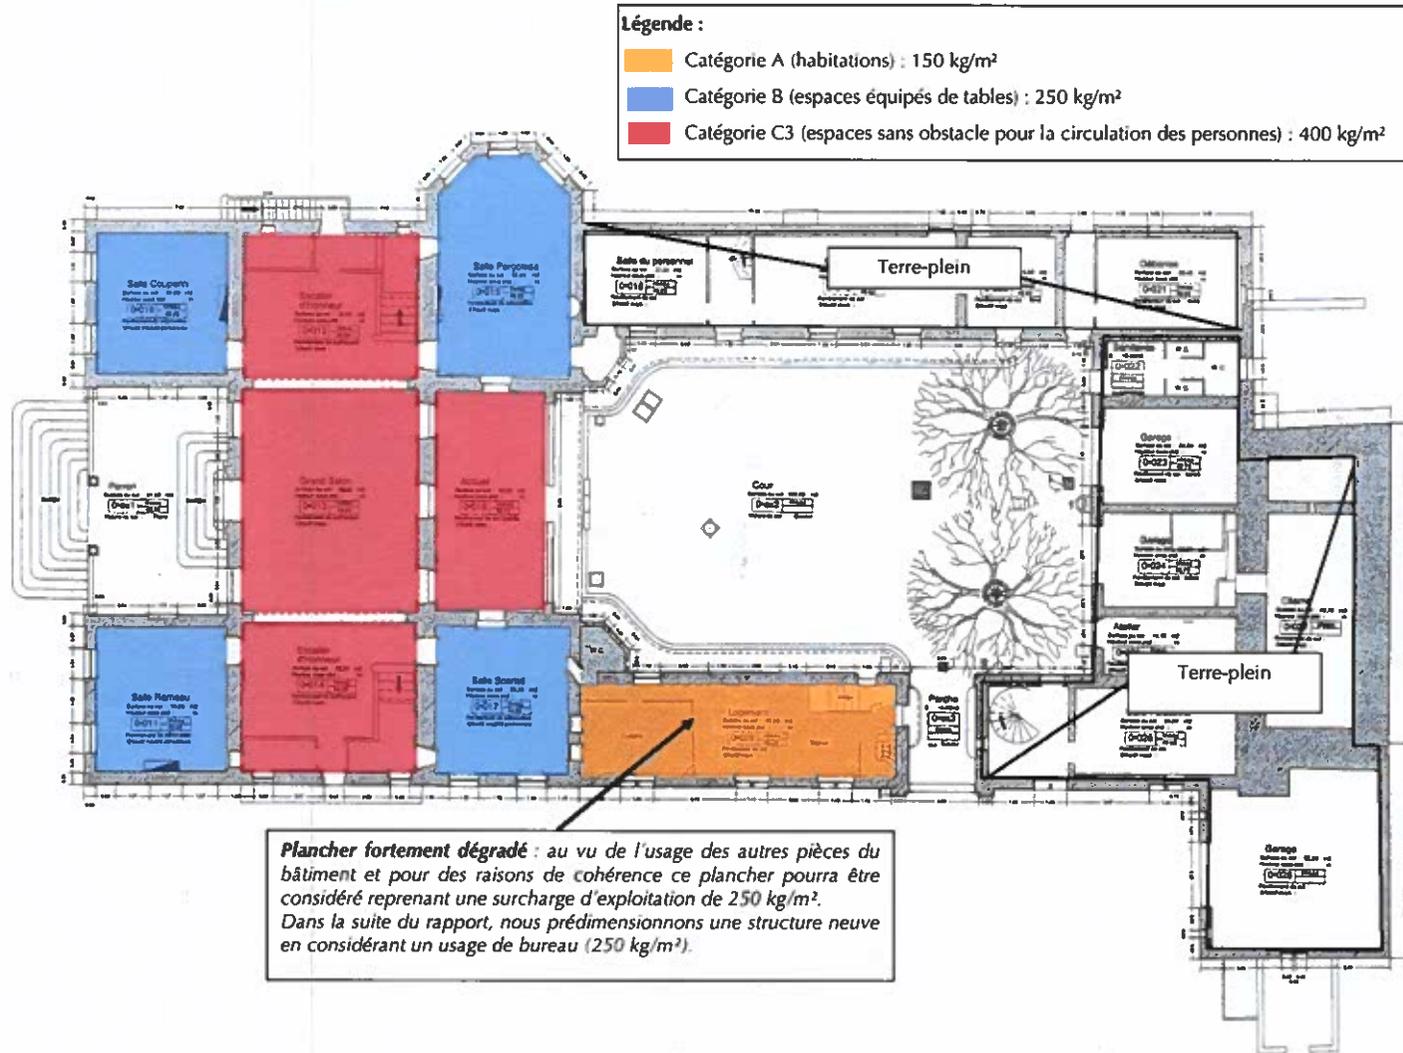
Cartographie des surcharges d'exploitation, plancher bas du rez-de-chaussée, état existant, fond de plan transmis par l'architecte
